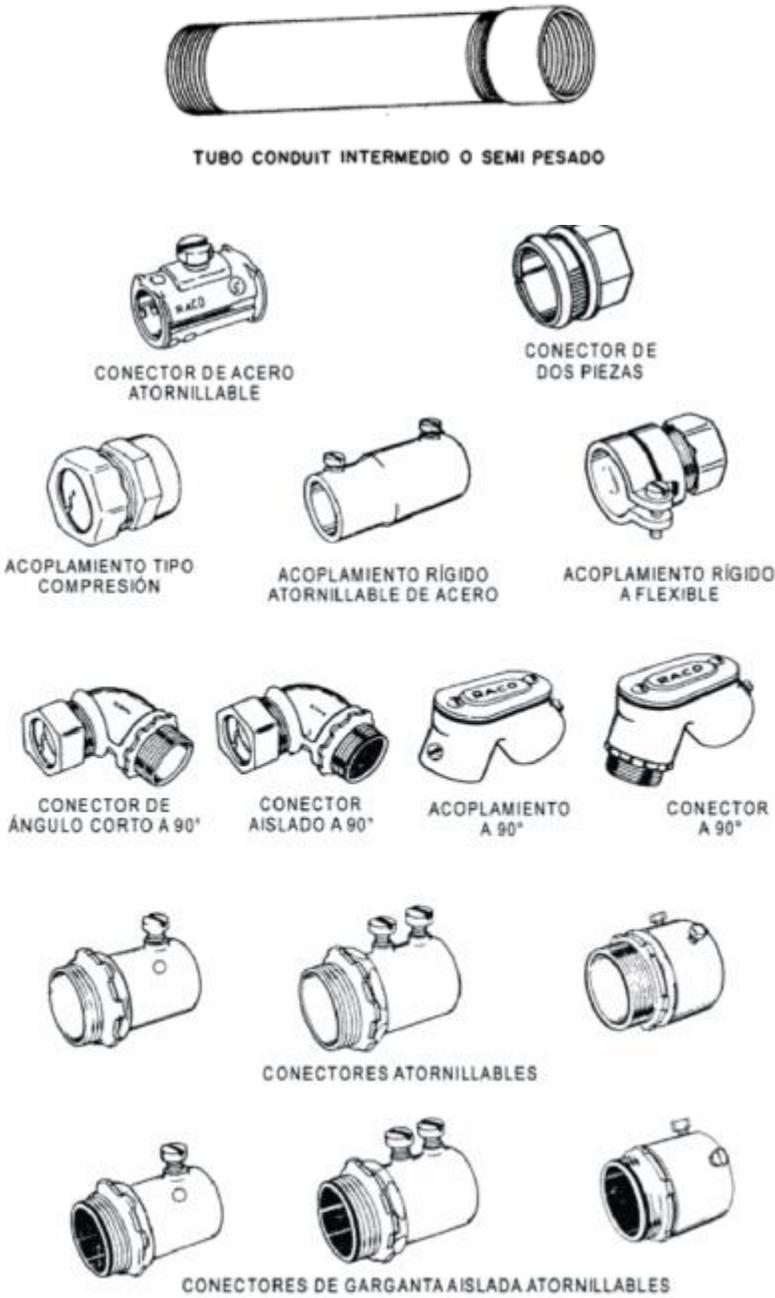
Tubo conduit metálico rígido conectores para tubos rígidos
